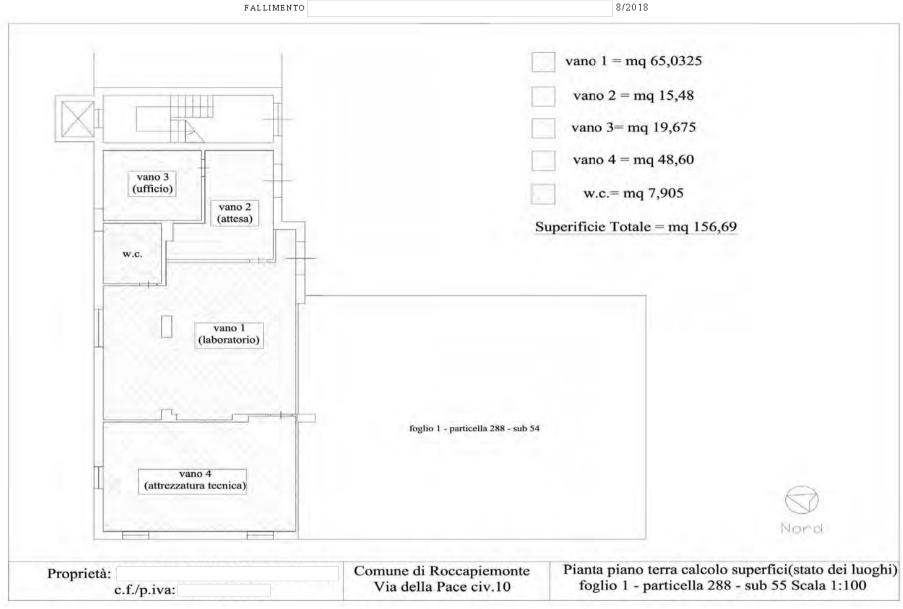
rappresentazione planimetrica con calcolo superfici locale commerciale fgl. 1 p.lla 488 sub 55
